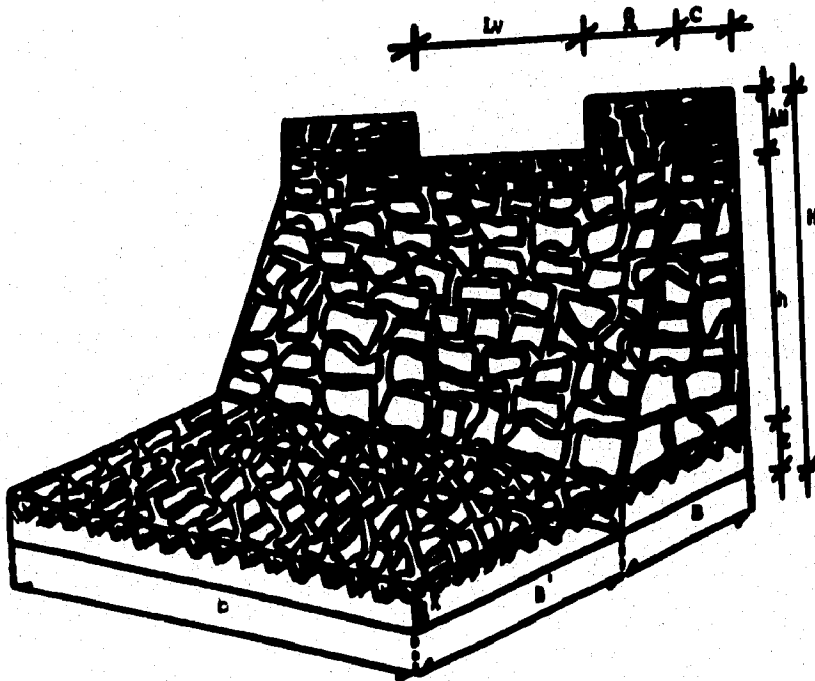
Vista de la sección transversal de la cortina en presas de piedra acomodada.
